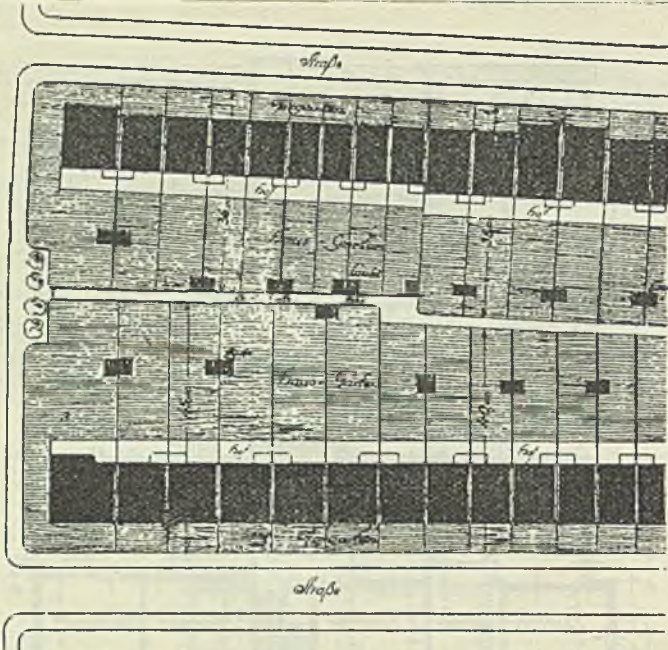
Bebauungsplan für eine Reihenhausanlage des Berliner Beamtenwohnvereins
